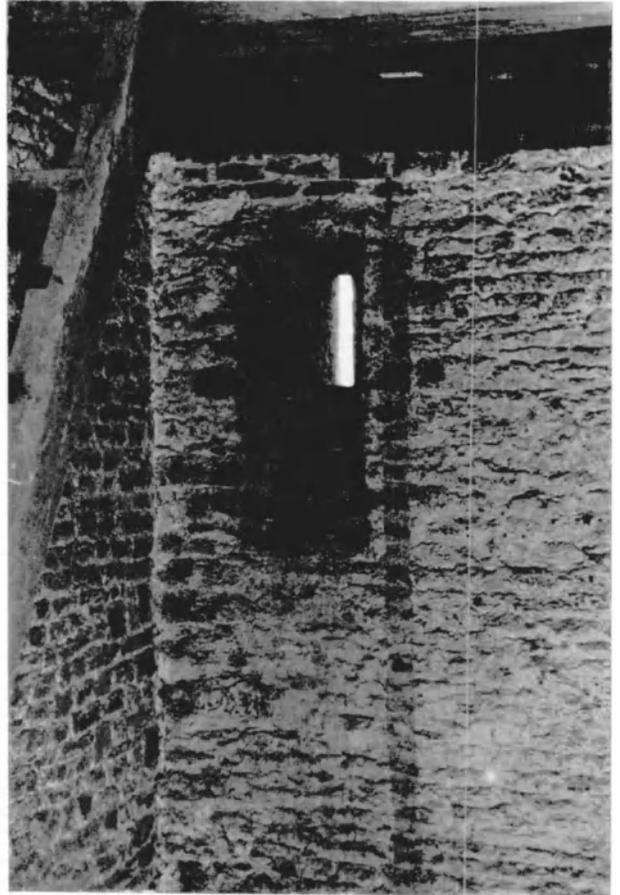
Tamines. Trace laissée sur le mur est par la cloison cachant l'escalier du second.
